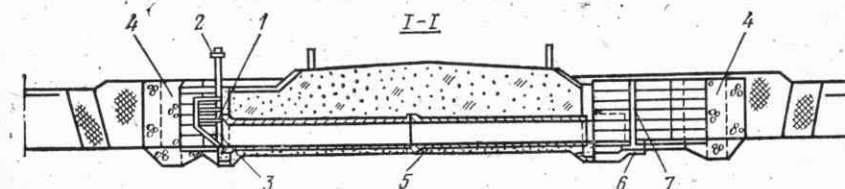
Трубчатый шлюз-регулятор с коробчатым затвором:
